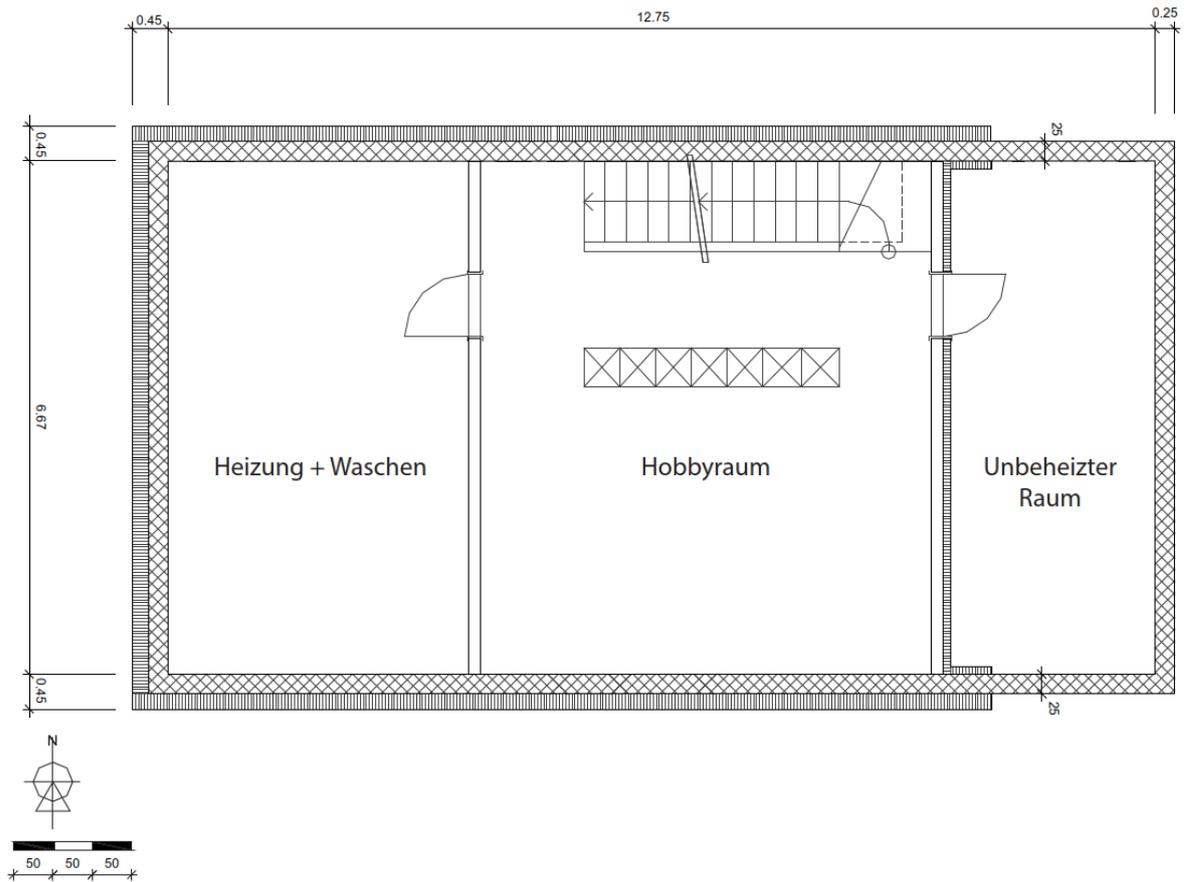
Grundriss Untergeschoss für Gebäudesimulation
